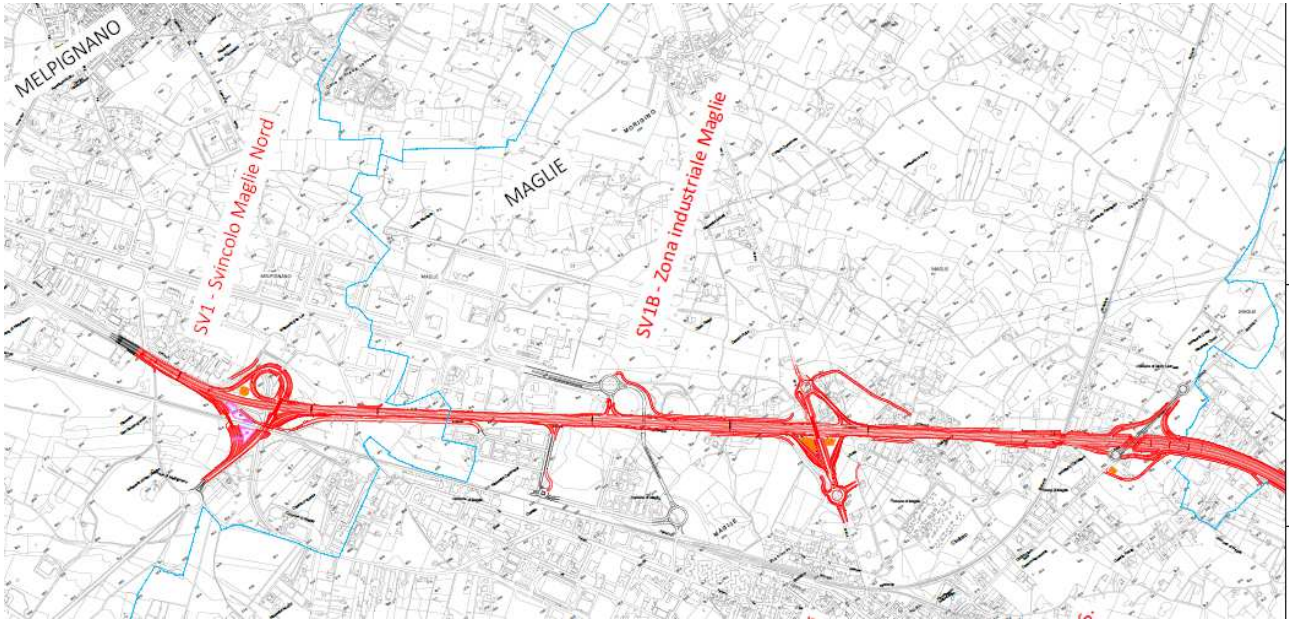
Planimetria complessiva dell'intervento su base CTR – 1 di 5
